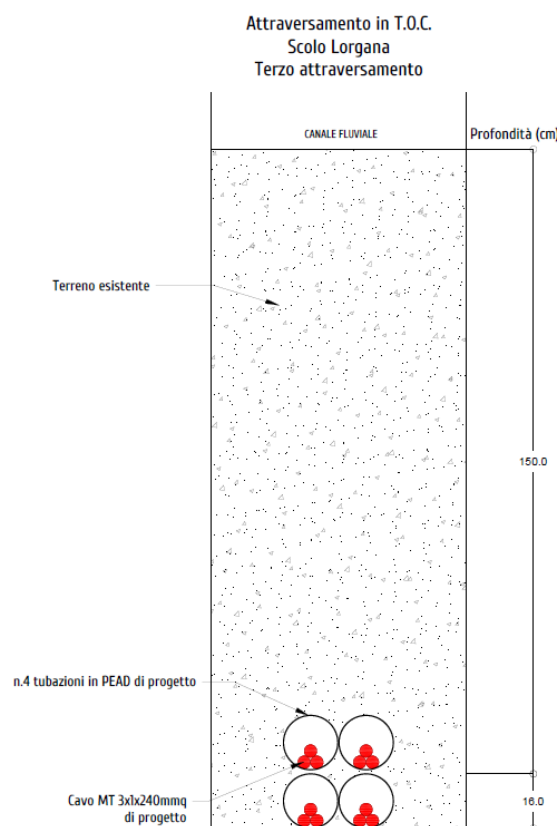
Sezione trasversale – Terzo attraversamento in T.O.C.
